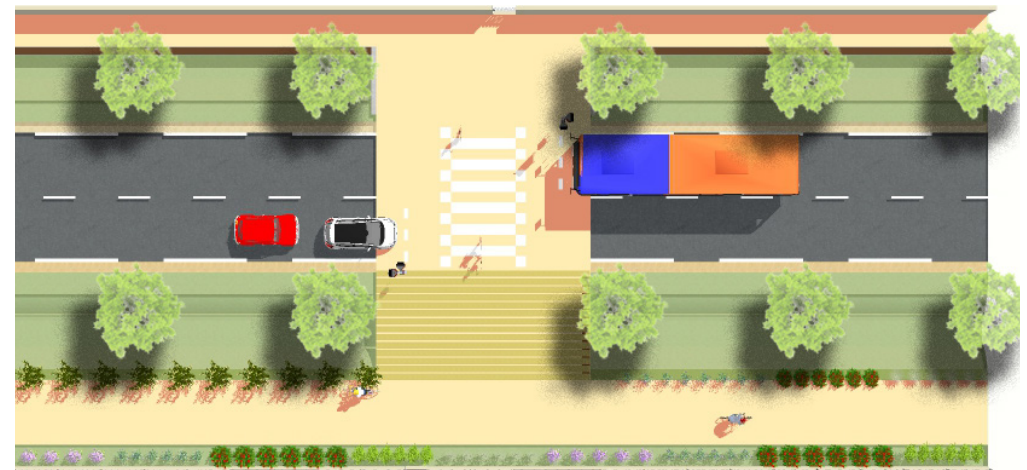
Vue en plan : traversée sécurisée piétons et cycles - av. Pieree Bérégovoy
